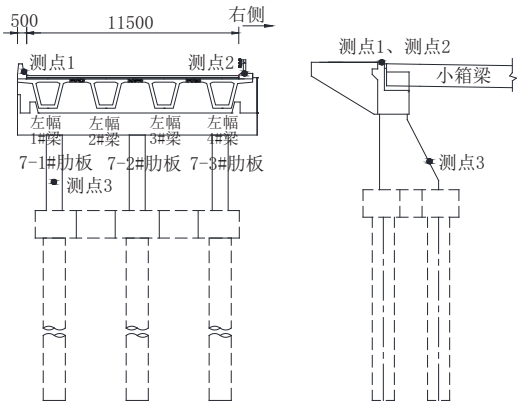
左幅桥 7# 桥台沉降观测点布置示意图(单位:mm)
